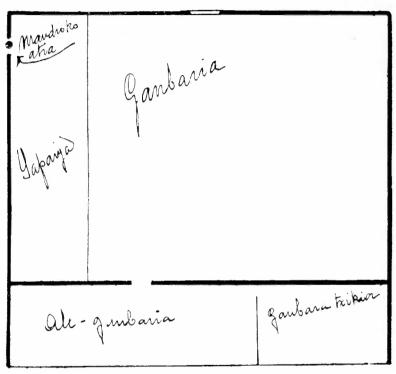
Caserío Ibarguren (Zumárraga): planta baja.
